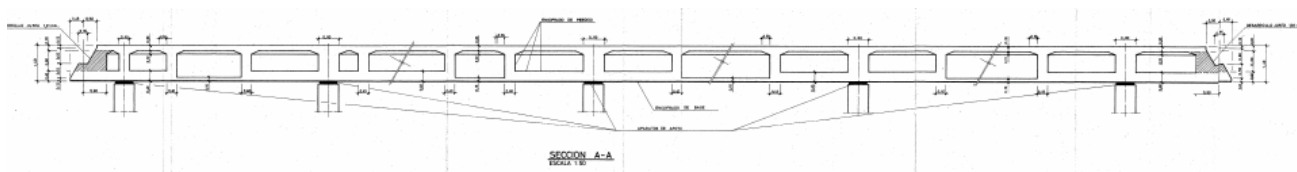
Sección tipo de la losa tomada de los planos del proyecto "as built"
